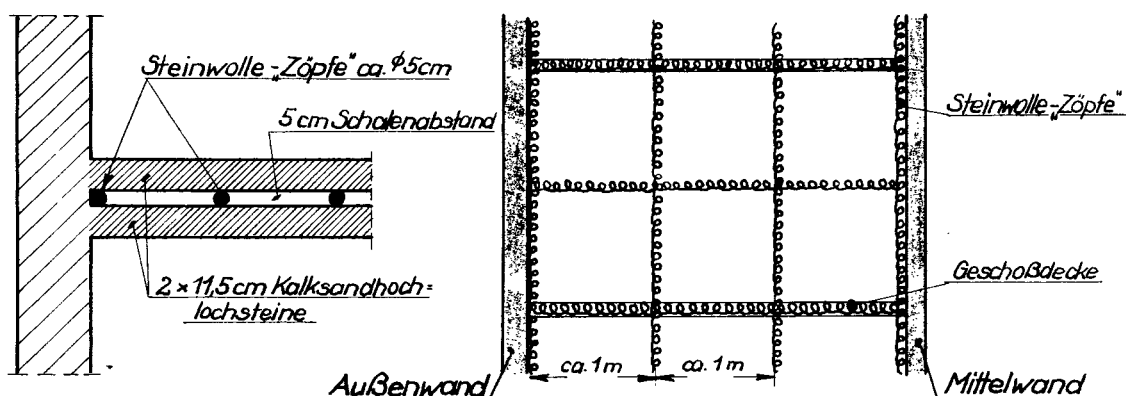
Konstruktiver Aufbau der Wohnungstrennwände im Grundriß und Querschnitt.
